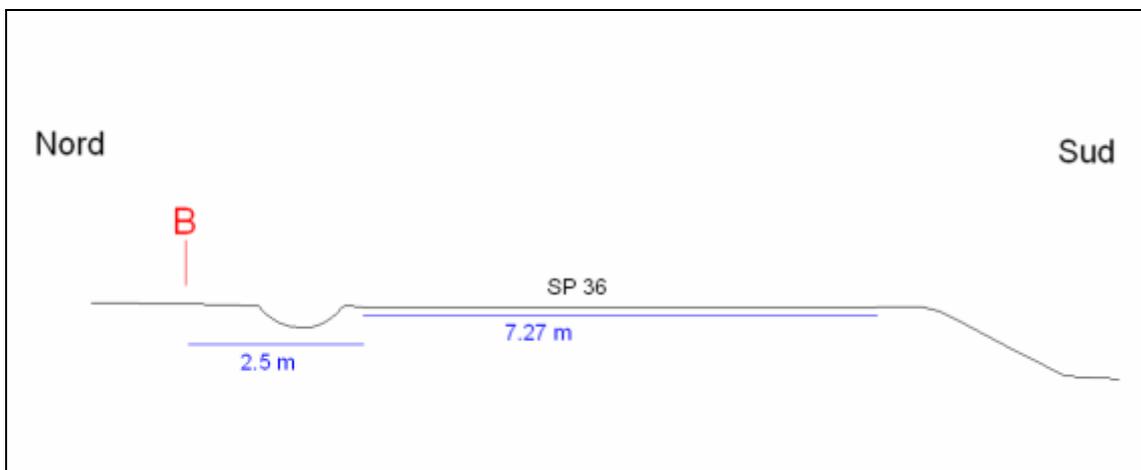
Sezione schematica del tratto stradale di interesse (SP36)
